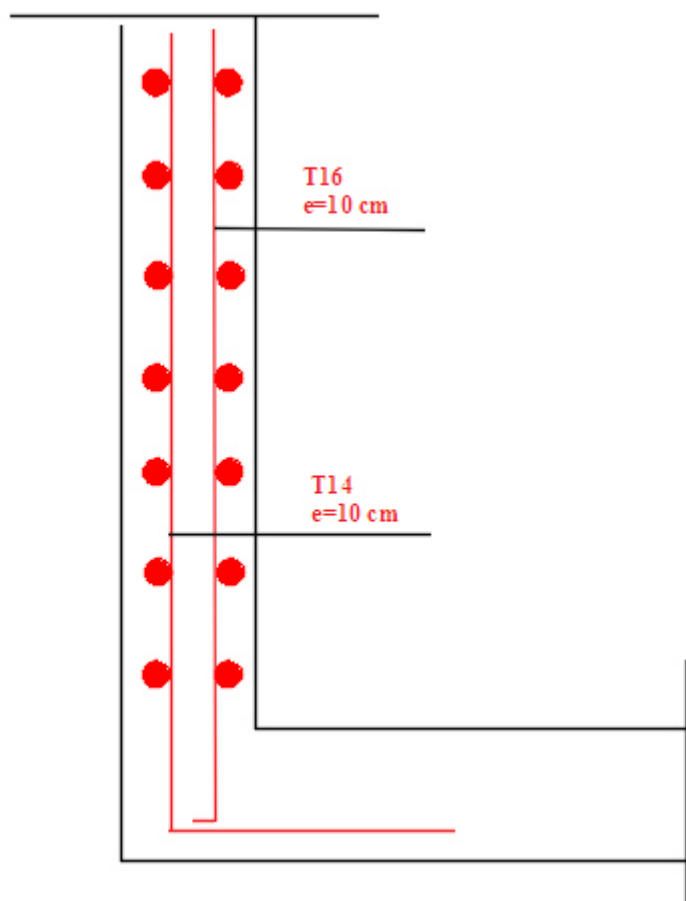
Schéma de ferrailage (coupe longitudinale) du voile périphérique
